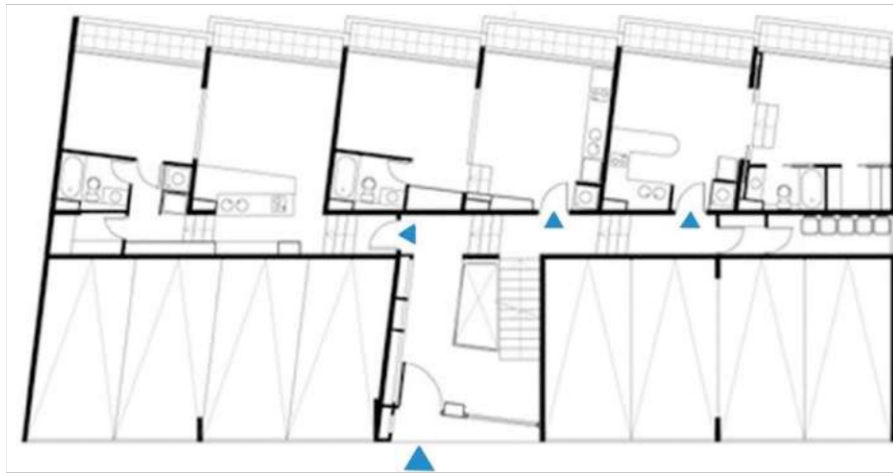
Accesos principales // Fuente: (Mendizábal, 2009).
